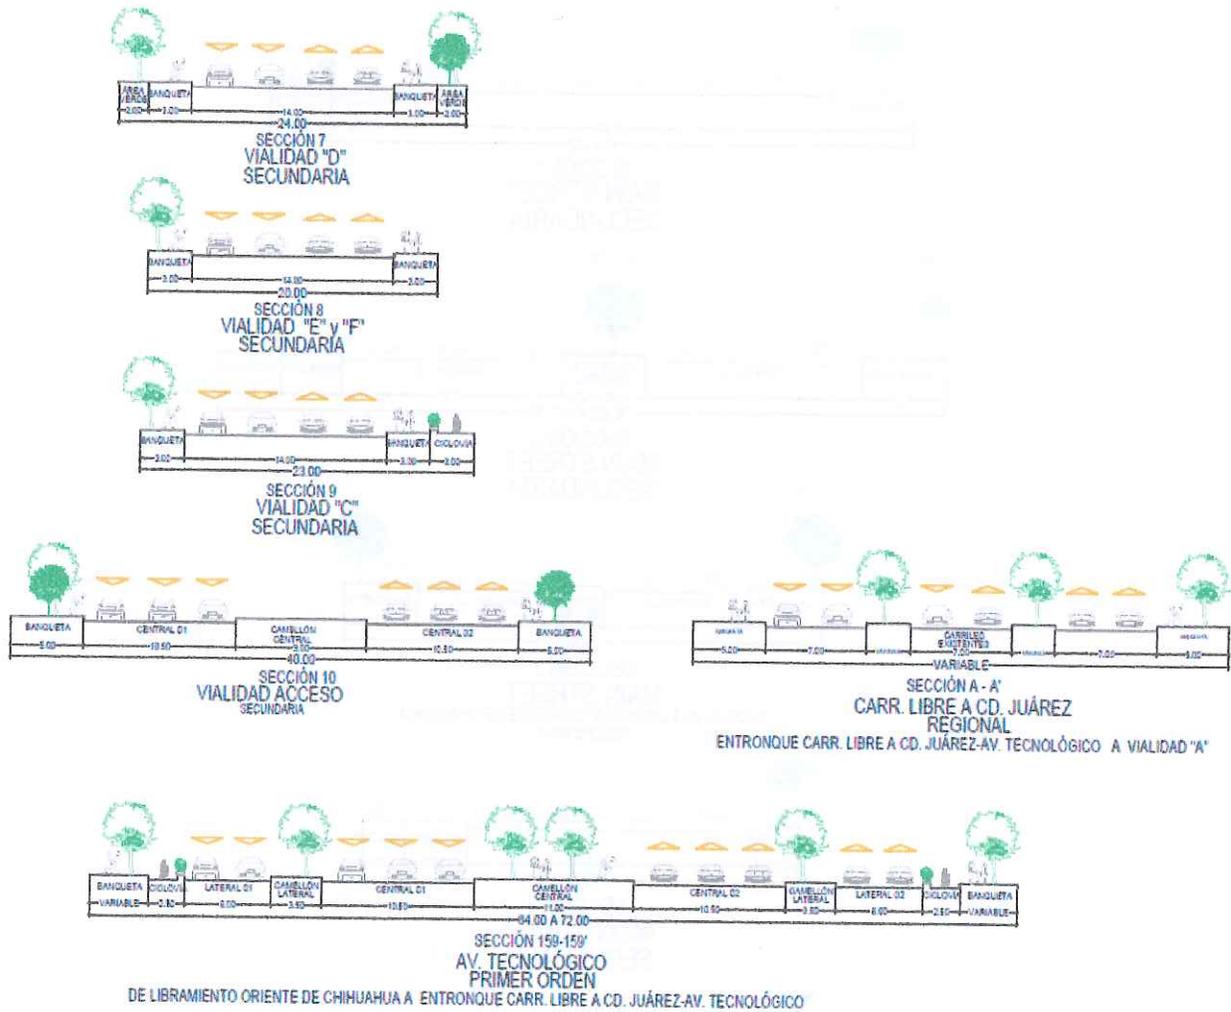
E-02.1 y E-02.2. Secciones Viales de Estructura Vial Plan Maestro Distrito Norte. Fuente. Elaboración Propia
